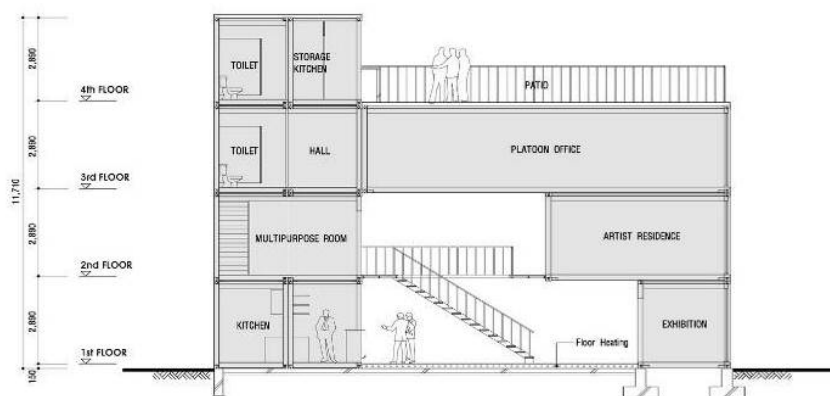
Vista interior e corte (s/escala). Platoon Kunsthalle (Platoon 2009/U-il Architects & Engineers 2009).
